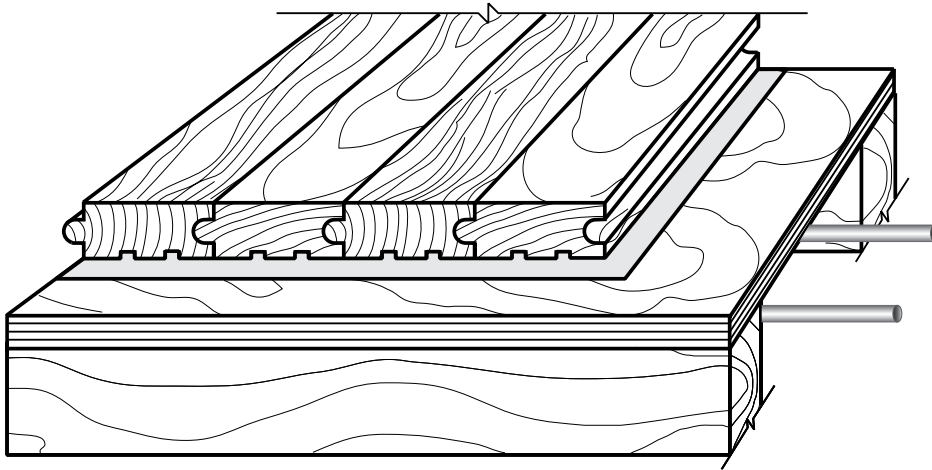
Plancher en bois cloué sur un faux-plancher
